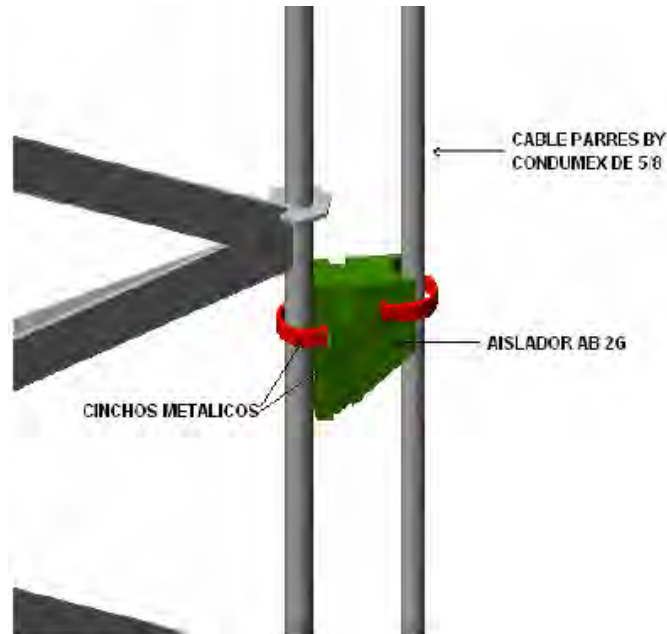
Sujeción del aislador a la estructura de la torre con cinturones metálicos
